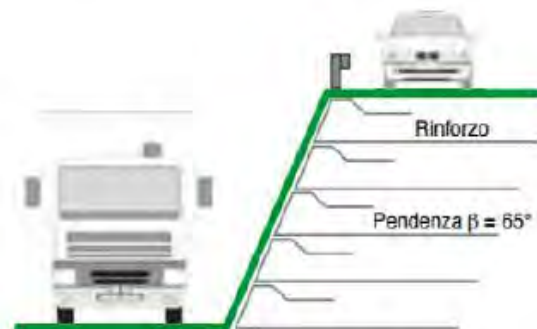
Sezione tipo rilevato in terra rinforzata
